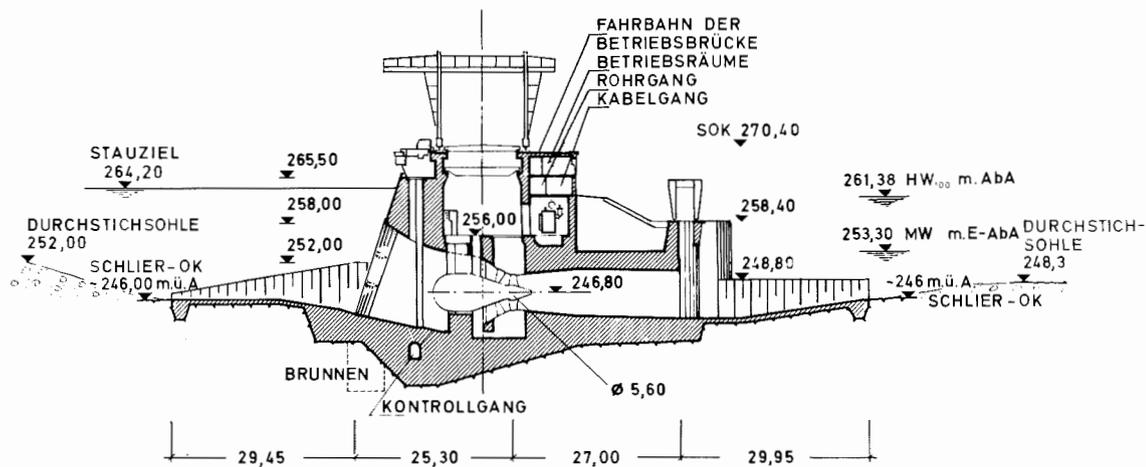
Kraftwerk Ottensheim-Wilhering: Krafthausquerschnitt, Kaplan-Turbine mit horizontaler Welle, niedere Bauweise, durchgehende Halle
